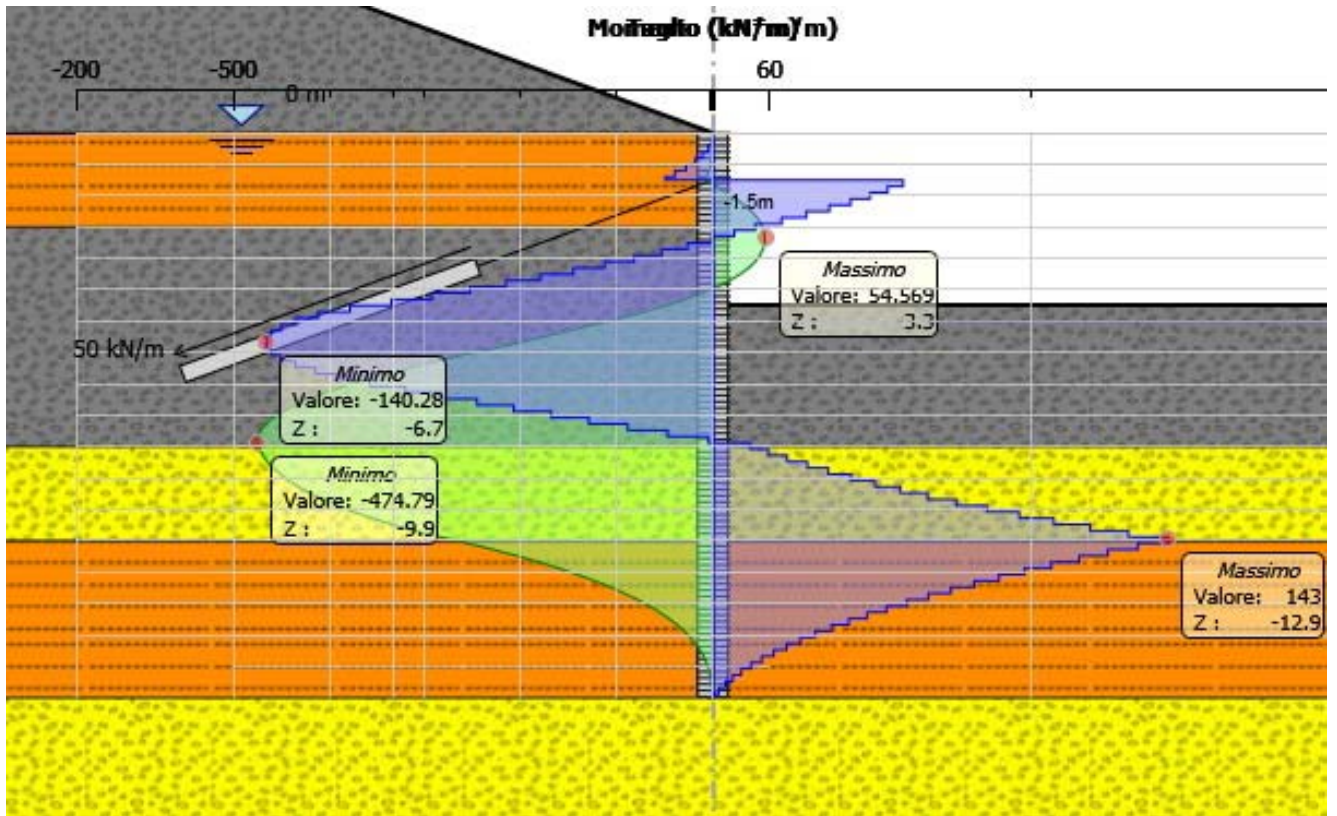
Spalla A - Sollecitazioni di design sugli elementi strutturali – Verifica SLU (A2+M2+R1) – kN*m/ml e kN/ml
